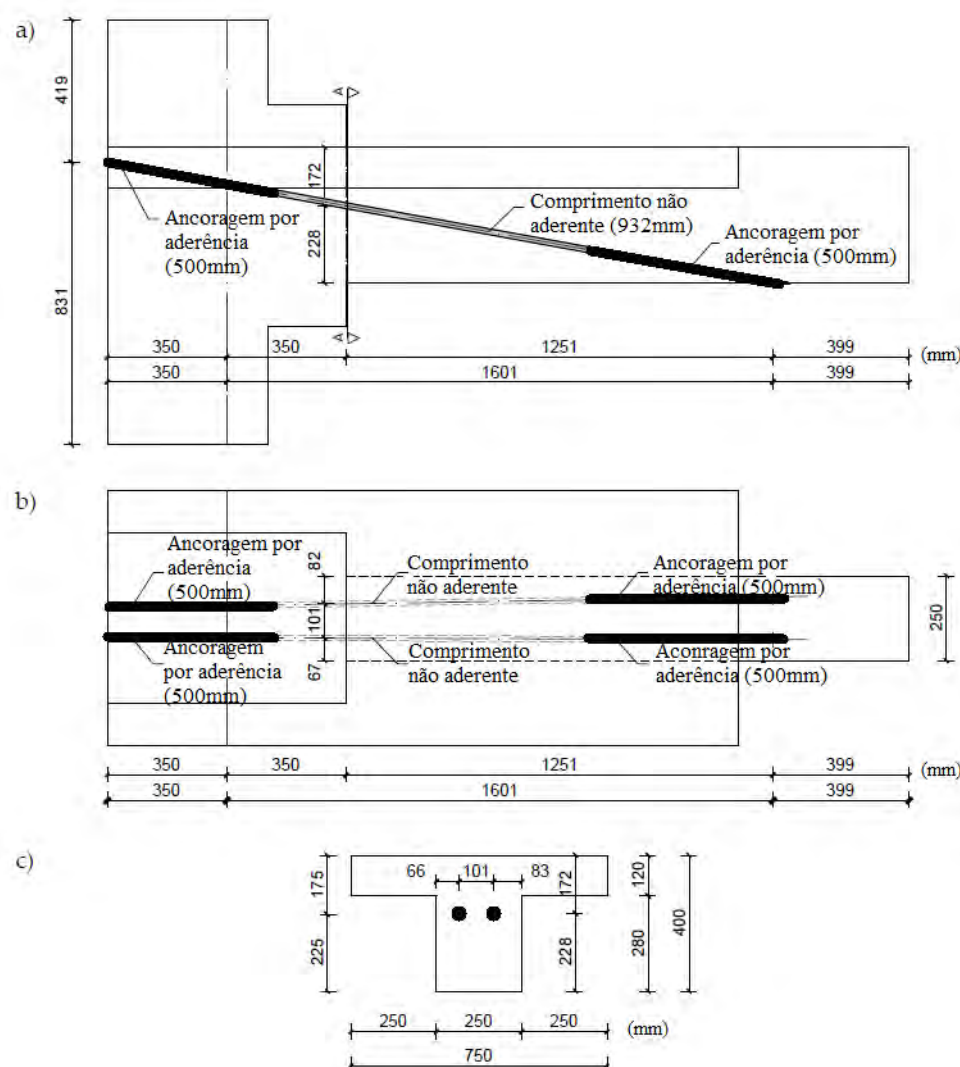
Geometria do traçado dos cordões de pré-esforço na viga CB2 (conforme construído): a) alçado, b) planta e c) corte A-A' (adaptado de [49]).
